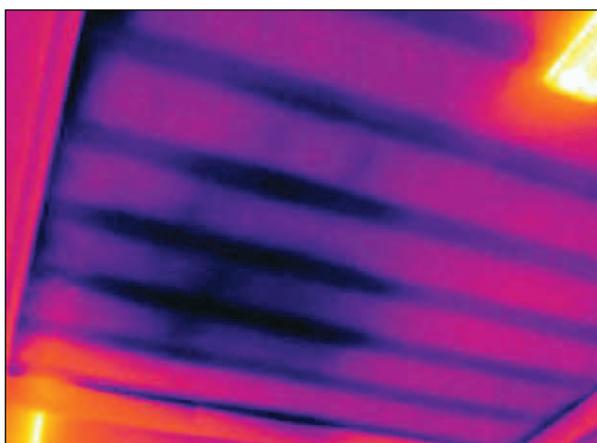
Fenomeno di infiltrazione attivo presente nell'Atrio 1 al secondo piano.
